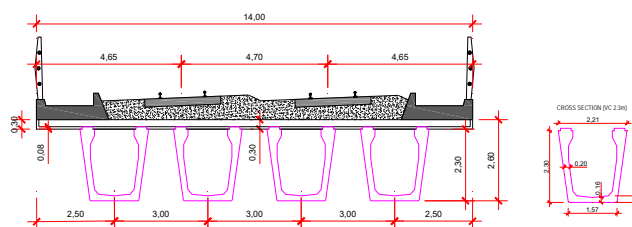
Secção transversal da ponte com vão máximo de 40m.
